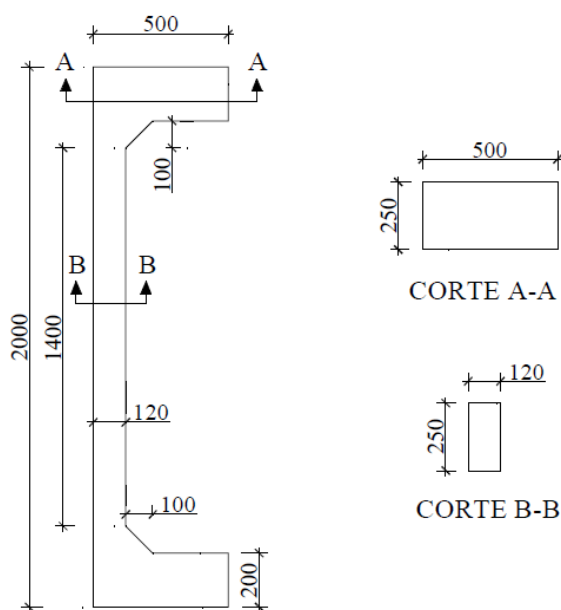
Dimensões dos pilares (ADORNO, 2004)
